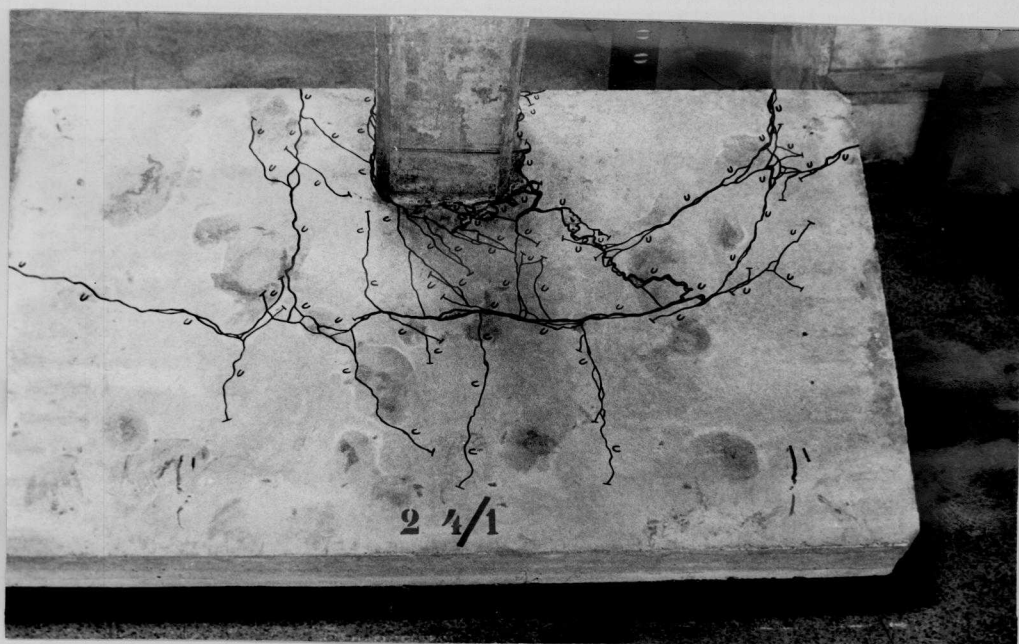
c - Fissuração na face inferior do modelo EdL 24/1.
